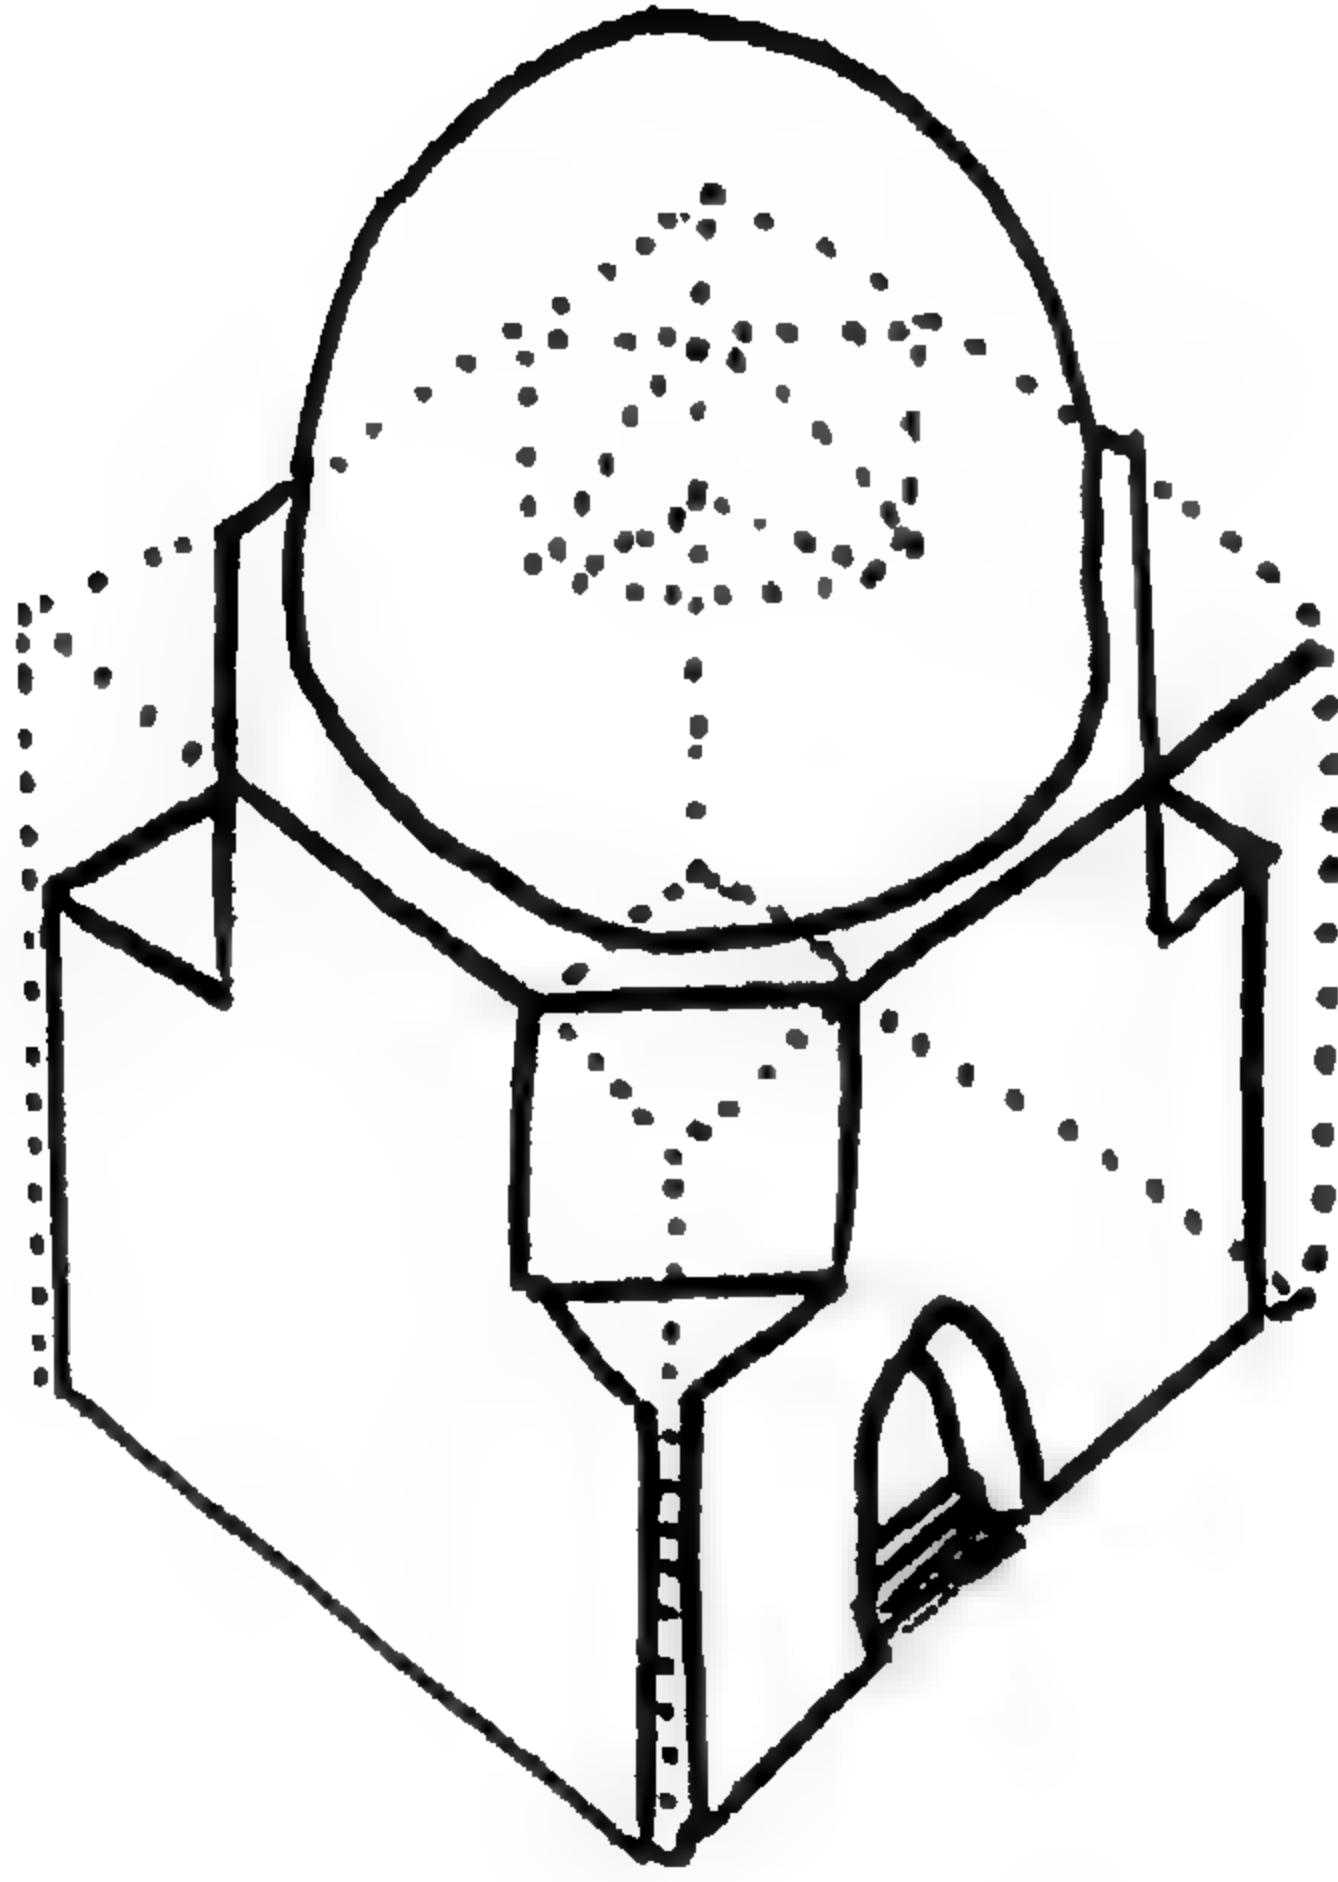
مسقط أفقي لقبة عمر بن ملقمة،
